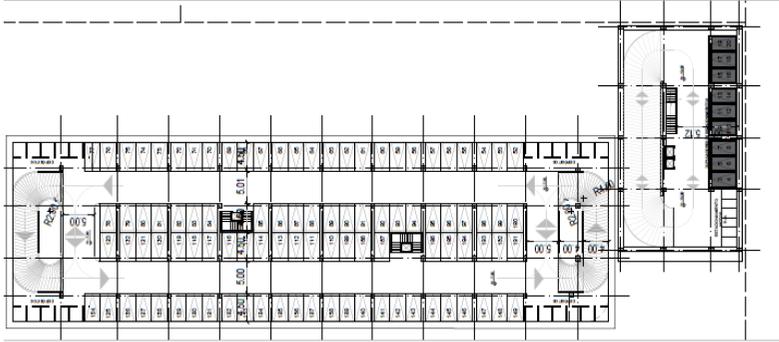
PF13. Planta Estacionamientos – Sótano 2
